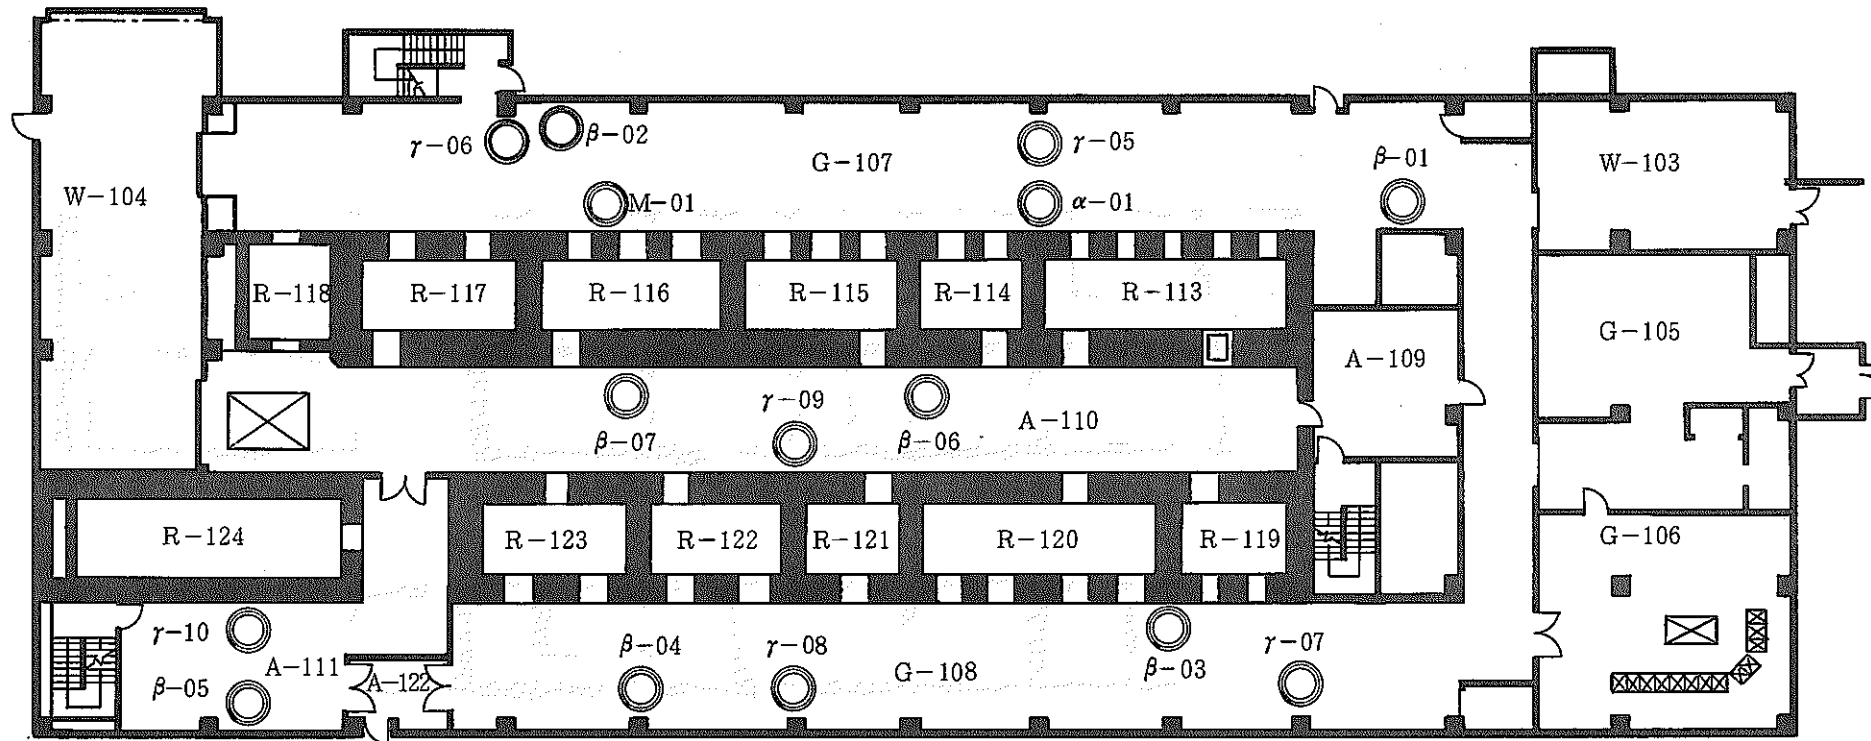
7 研究棟一階定置式モニタ配置図
